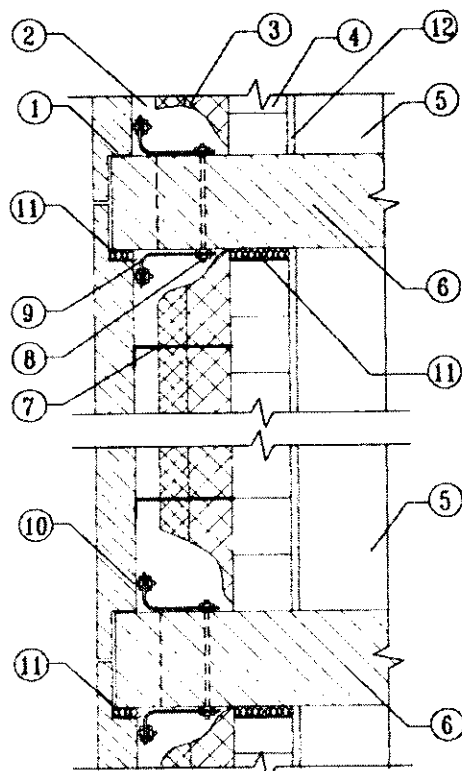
Схема устройства слоистых наружных стен с железобетонными декоративными экранами
